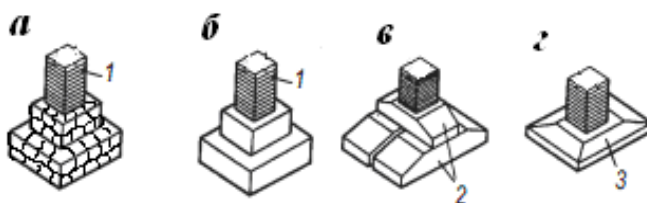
Стовпчасті фундаменти під цегляні стовпи: а – бутовий фундамент; б – теж бутобетонний; в – із залізобетонних блоків-подушок; г – із залізобетонного блока-плити; 1 – цегляний стовп; 2 – блок-подушка; 3 – блок-плита
